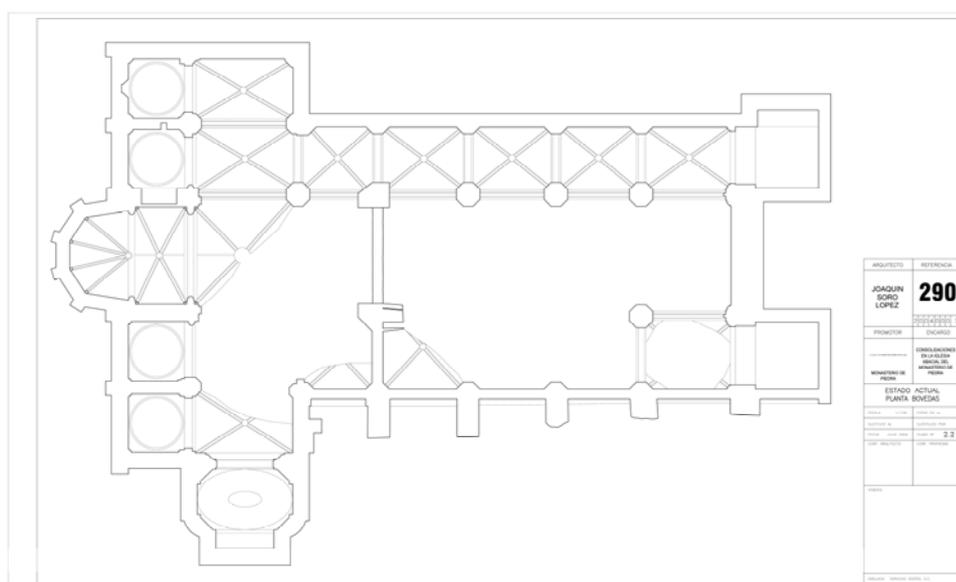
(Proyecto JUL 2004, plano 2.2.) ESTADO ACTUAL. PLANTA DE BÓVEDAS.
